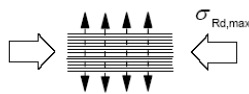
Bemessungswert der Festigkeit von Betonstreben mit Querzug
